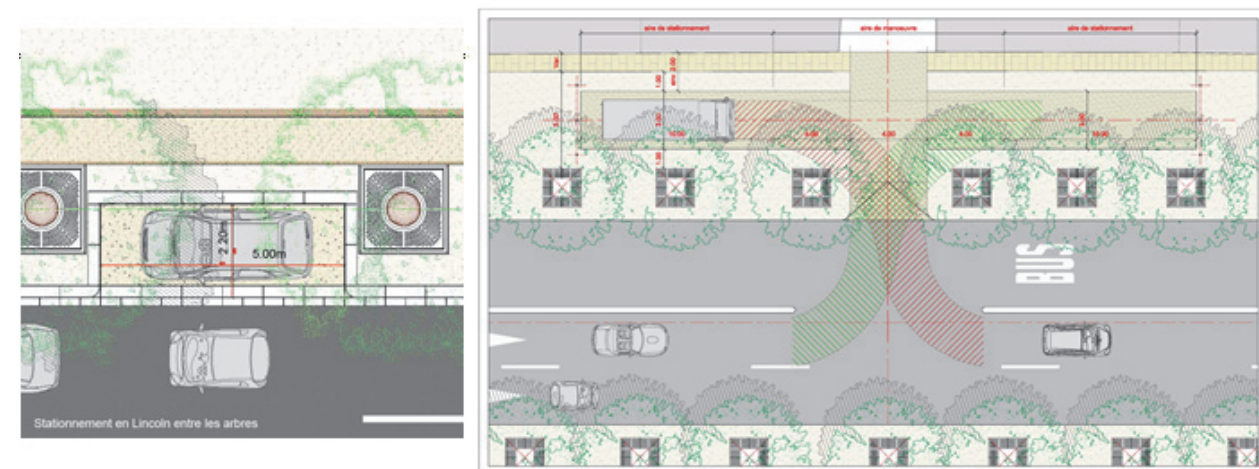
configuration type du stationnement sur trottoir extérieur et des places de livraisons sur trottoir intérieur
